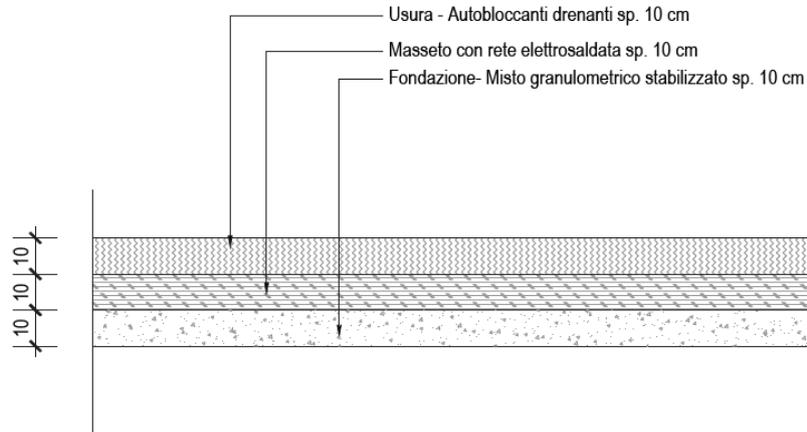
Pacchetto pavimentazione stalli parcheggio
